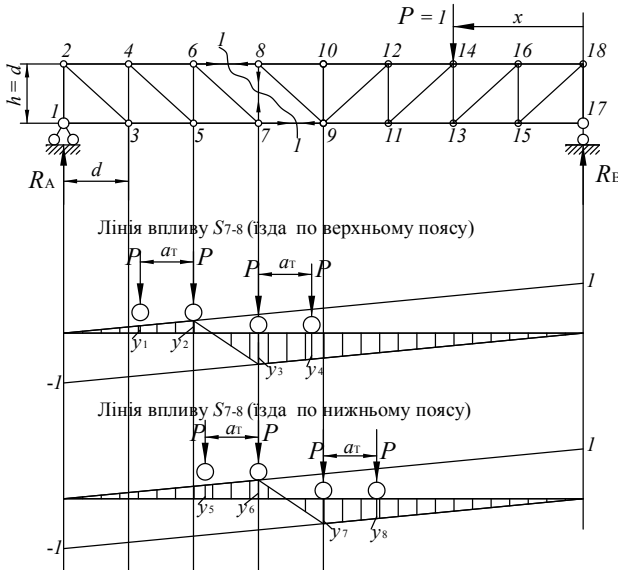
Лінії впливу стійки ферми при русі вантажного візка по верхньому і нижньому поясах
